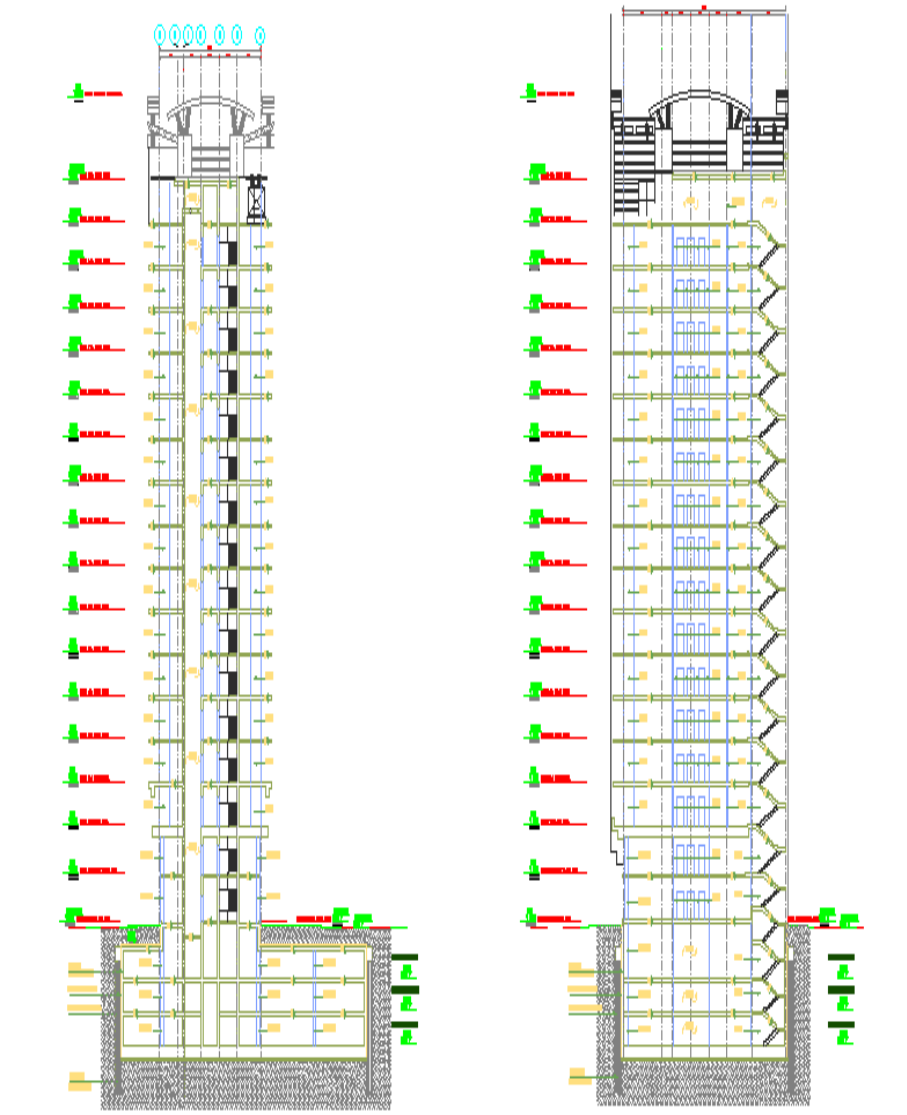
Vue en plan de la façade principale de la structure et coupe A-A de la structure
